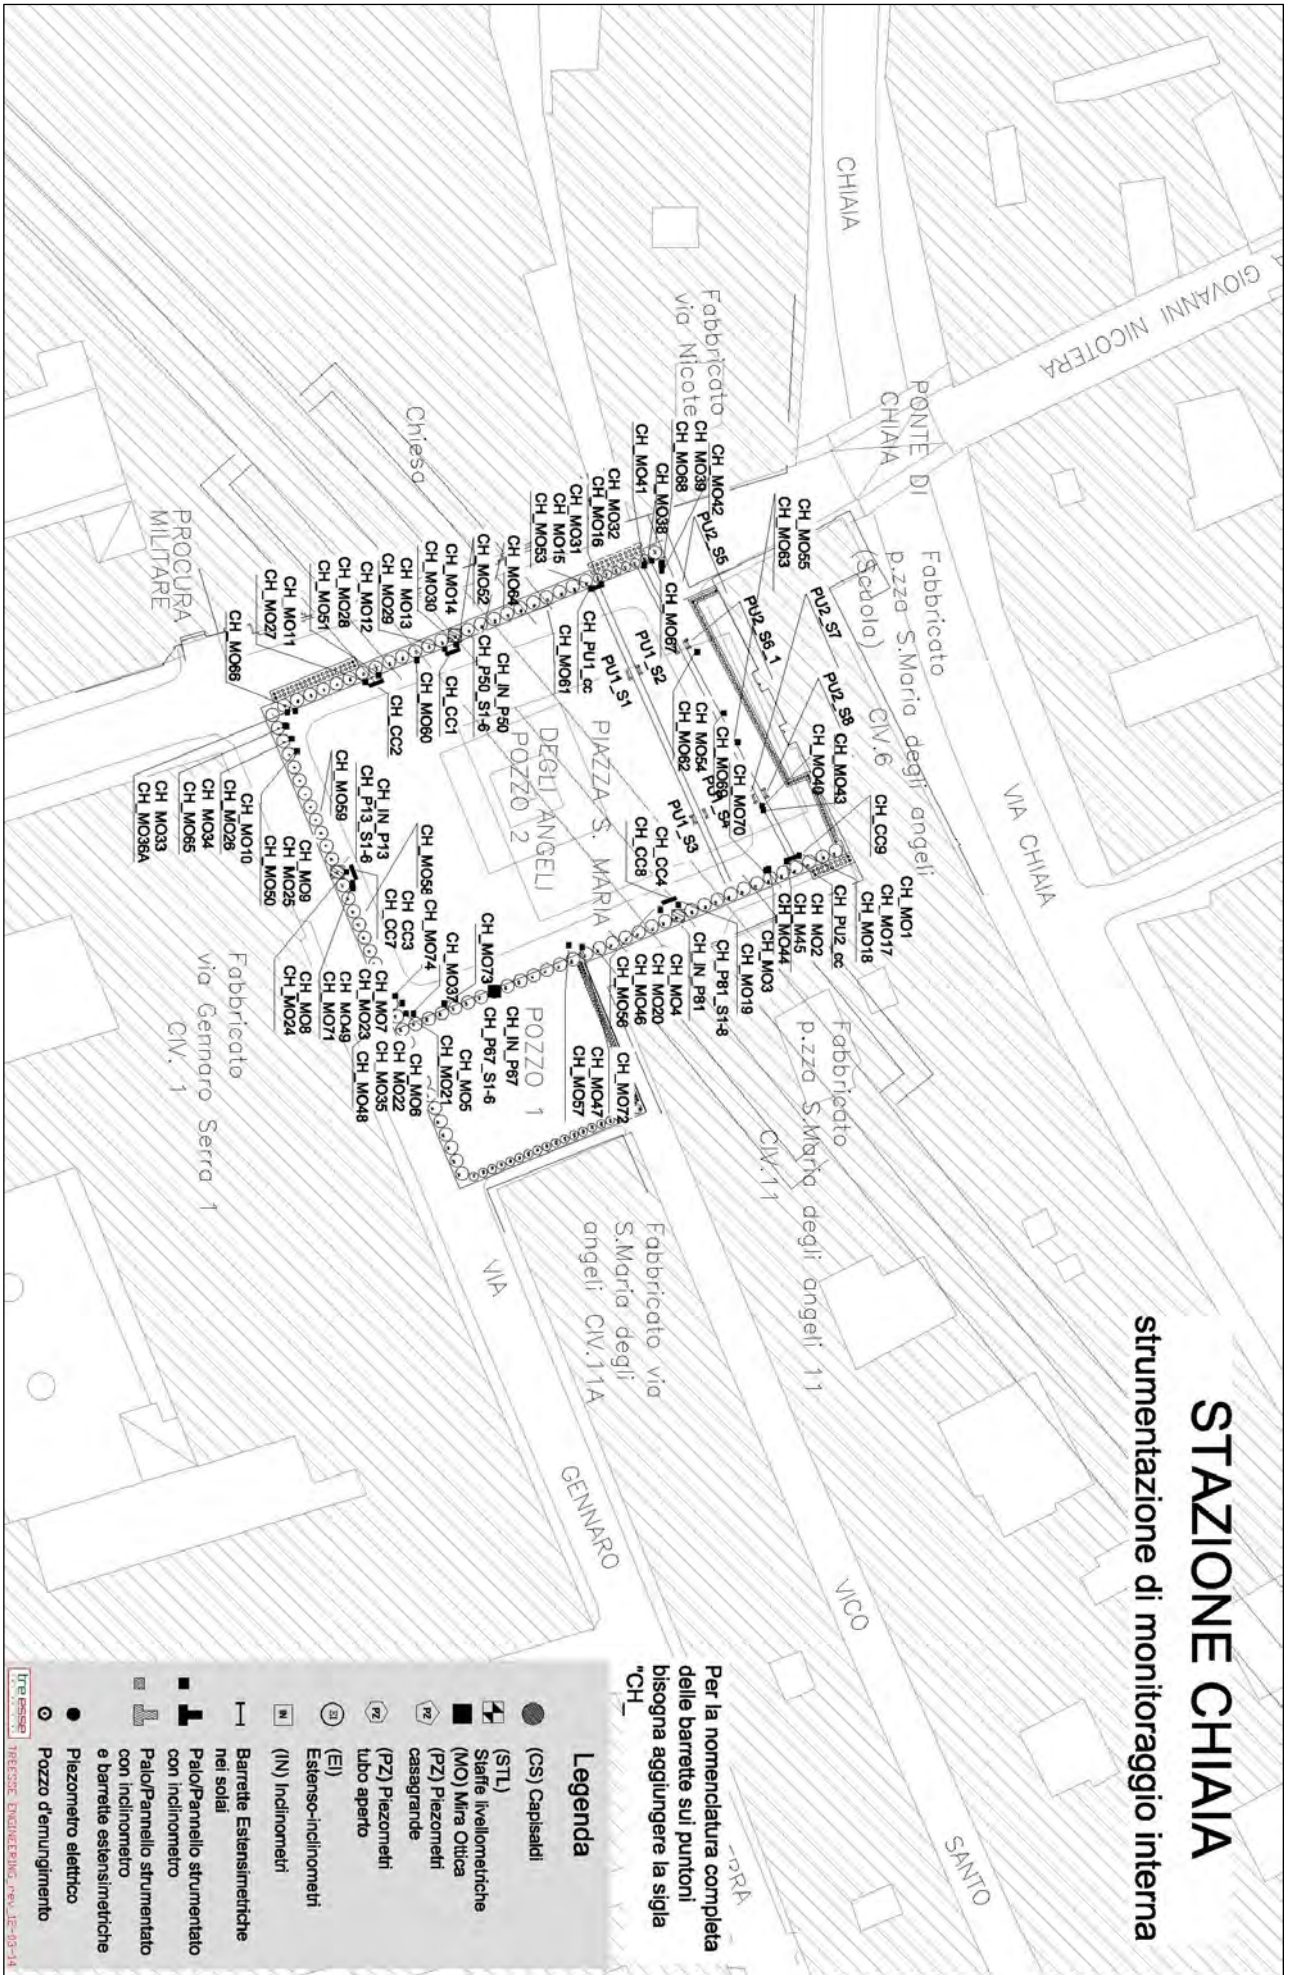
Planimetria pozzo stazione, raffigurante la disposizione della strumentazione di monitoraggio geotecnico interno installata.
